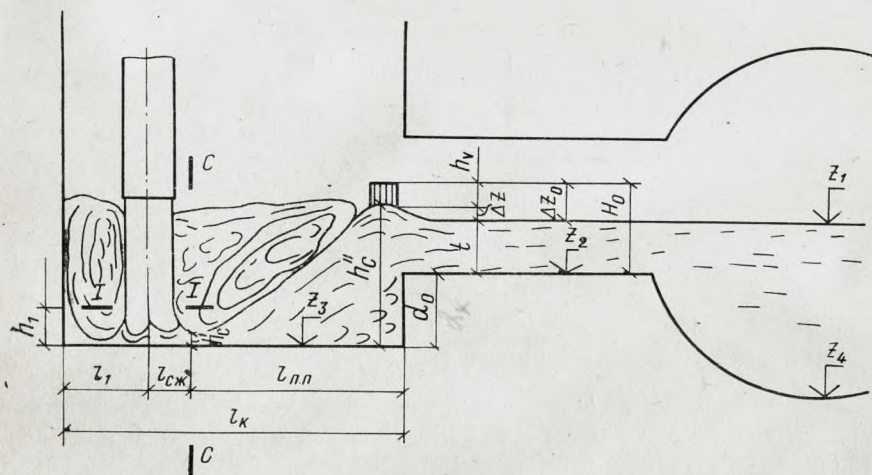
Гидравлическая схема к расчету прямоугольного водобойного колодца
